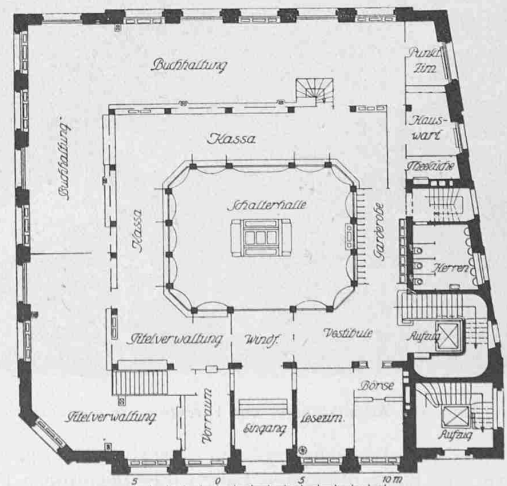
Grundriss vom Erdgeschoss.
